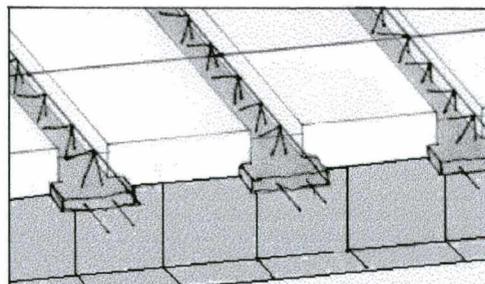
Laje com vigota treliçada apoiada na viga.
